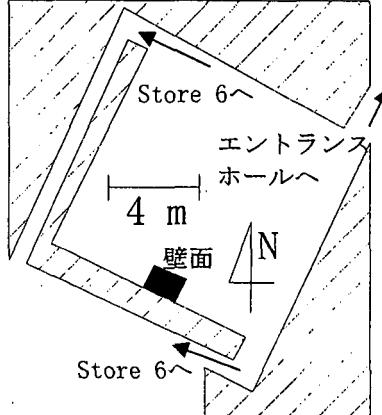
地下商店（Show room 6）の平面図. 天井高さ 2.5 m. 土被りの凝灰岩層厚 3.5 m.
